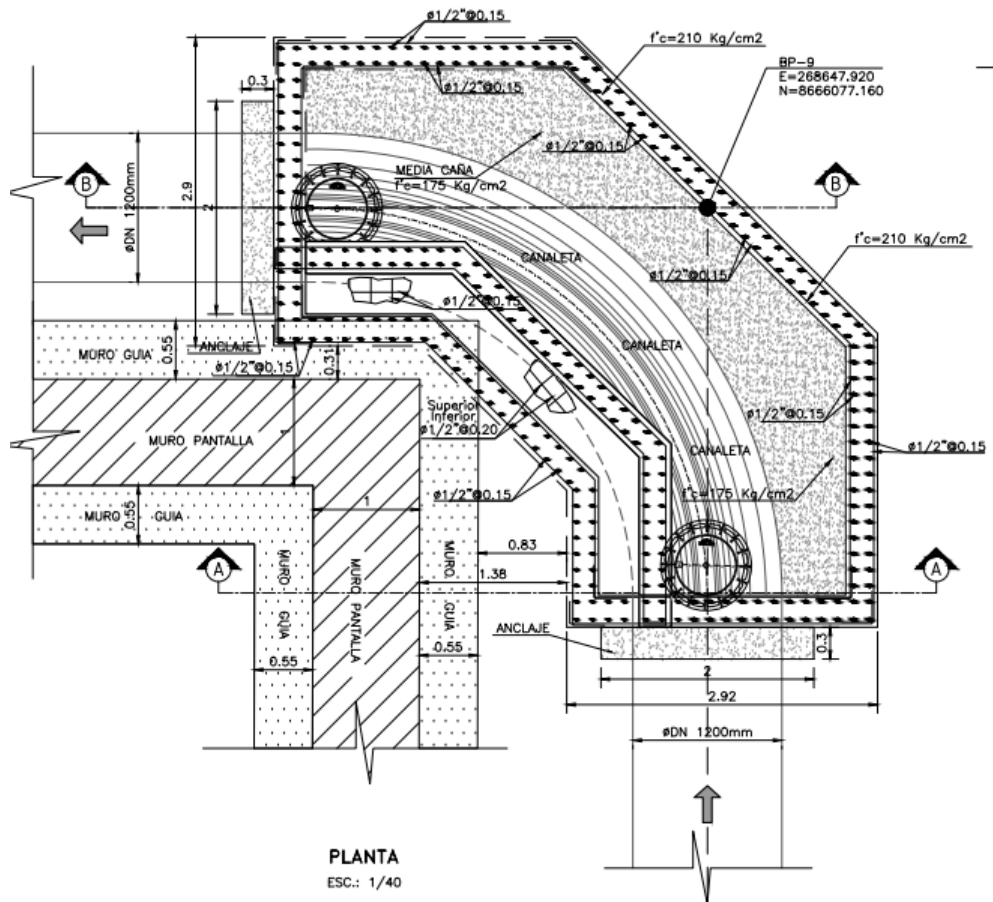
Detalle constructivo de Cámara Especial en BP-9
